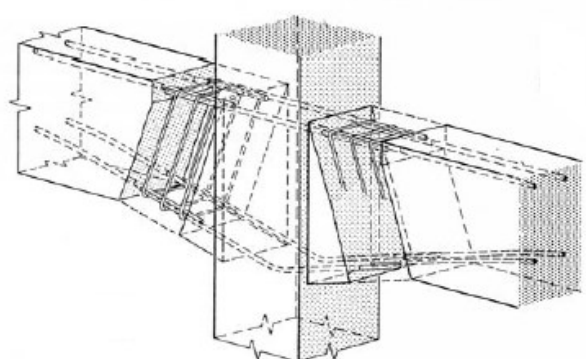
Ligação pilar-viga através de betonagem local (STUPRÉ, 1981).
